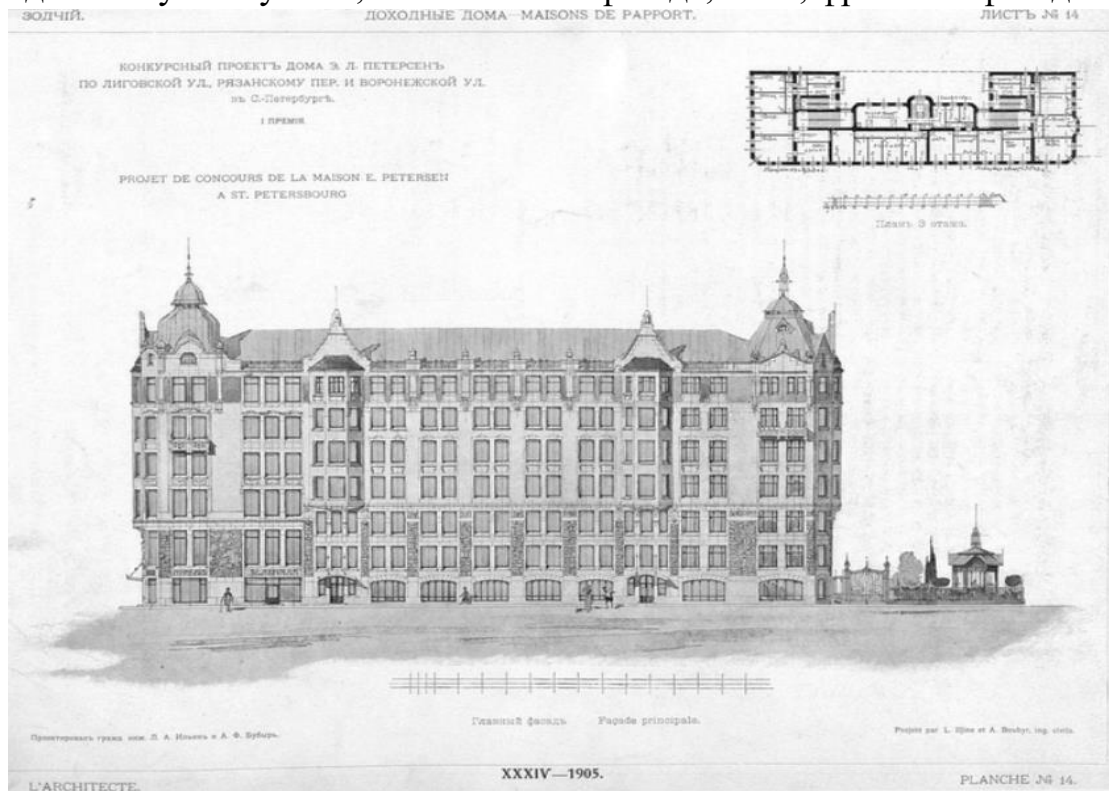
Конкурсные проект доходного дома в Санкт-Петербурге в линиях застройки: Лиговской ул., Рязанскому пер. и Воронежской ул., эскиз поэтажного плана и главный фасад. Зодчий №14.
